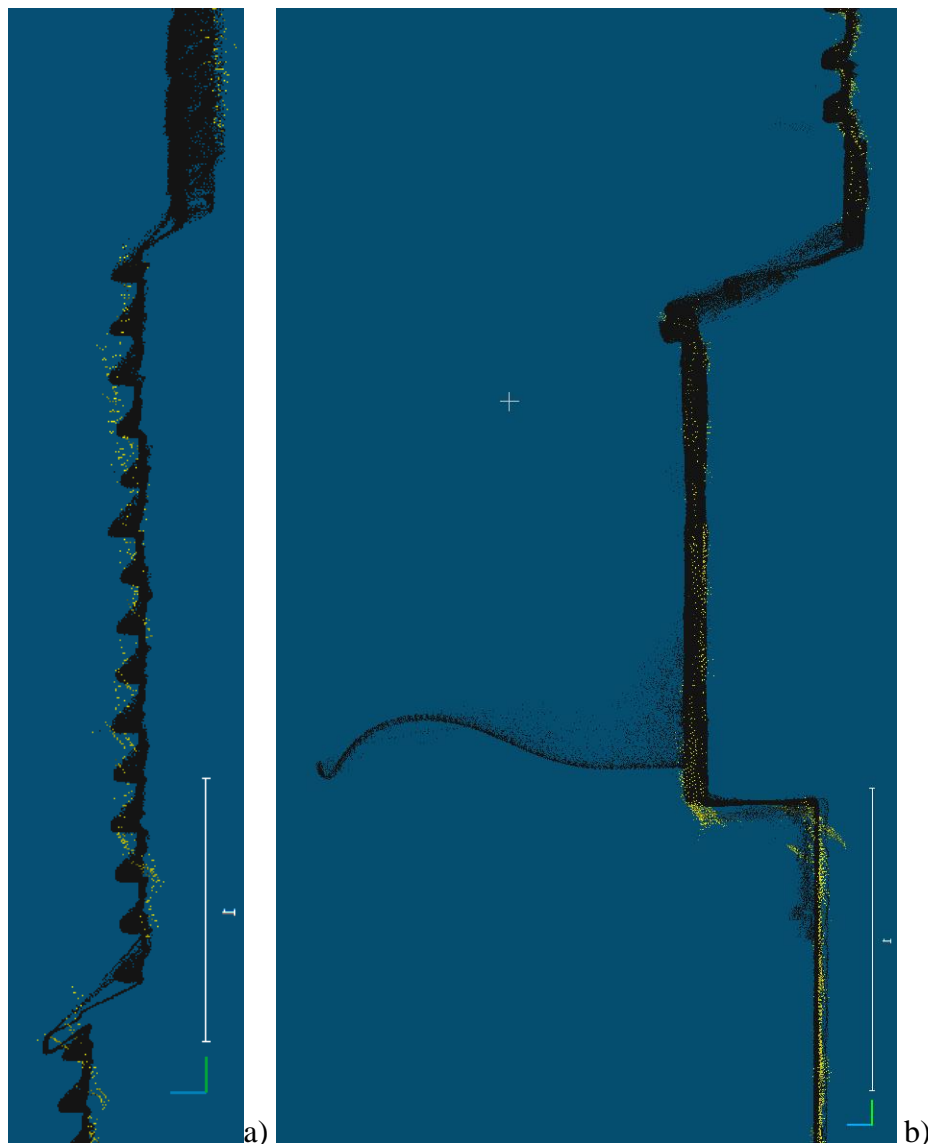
Sezione V2, dettaglio 5 (a) e sezione V2, dettaglio 3 (b).
